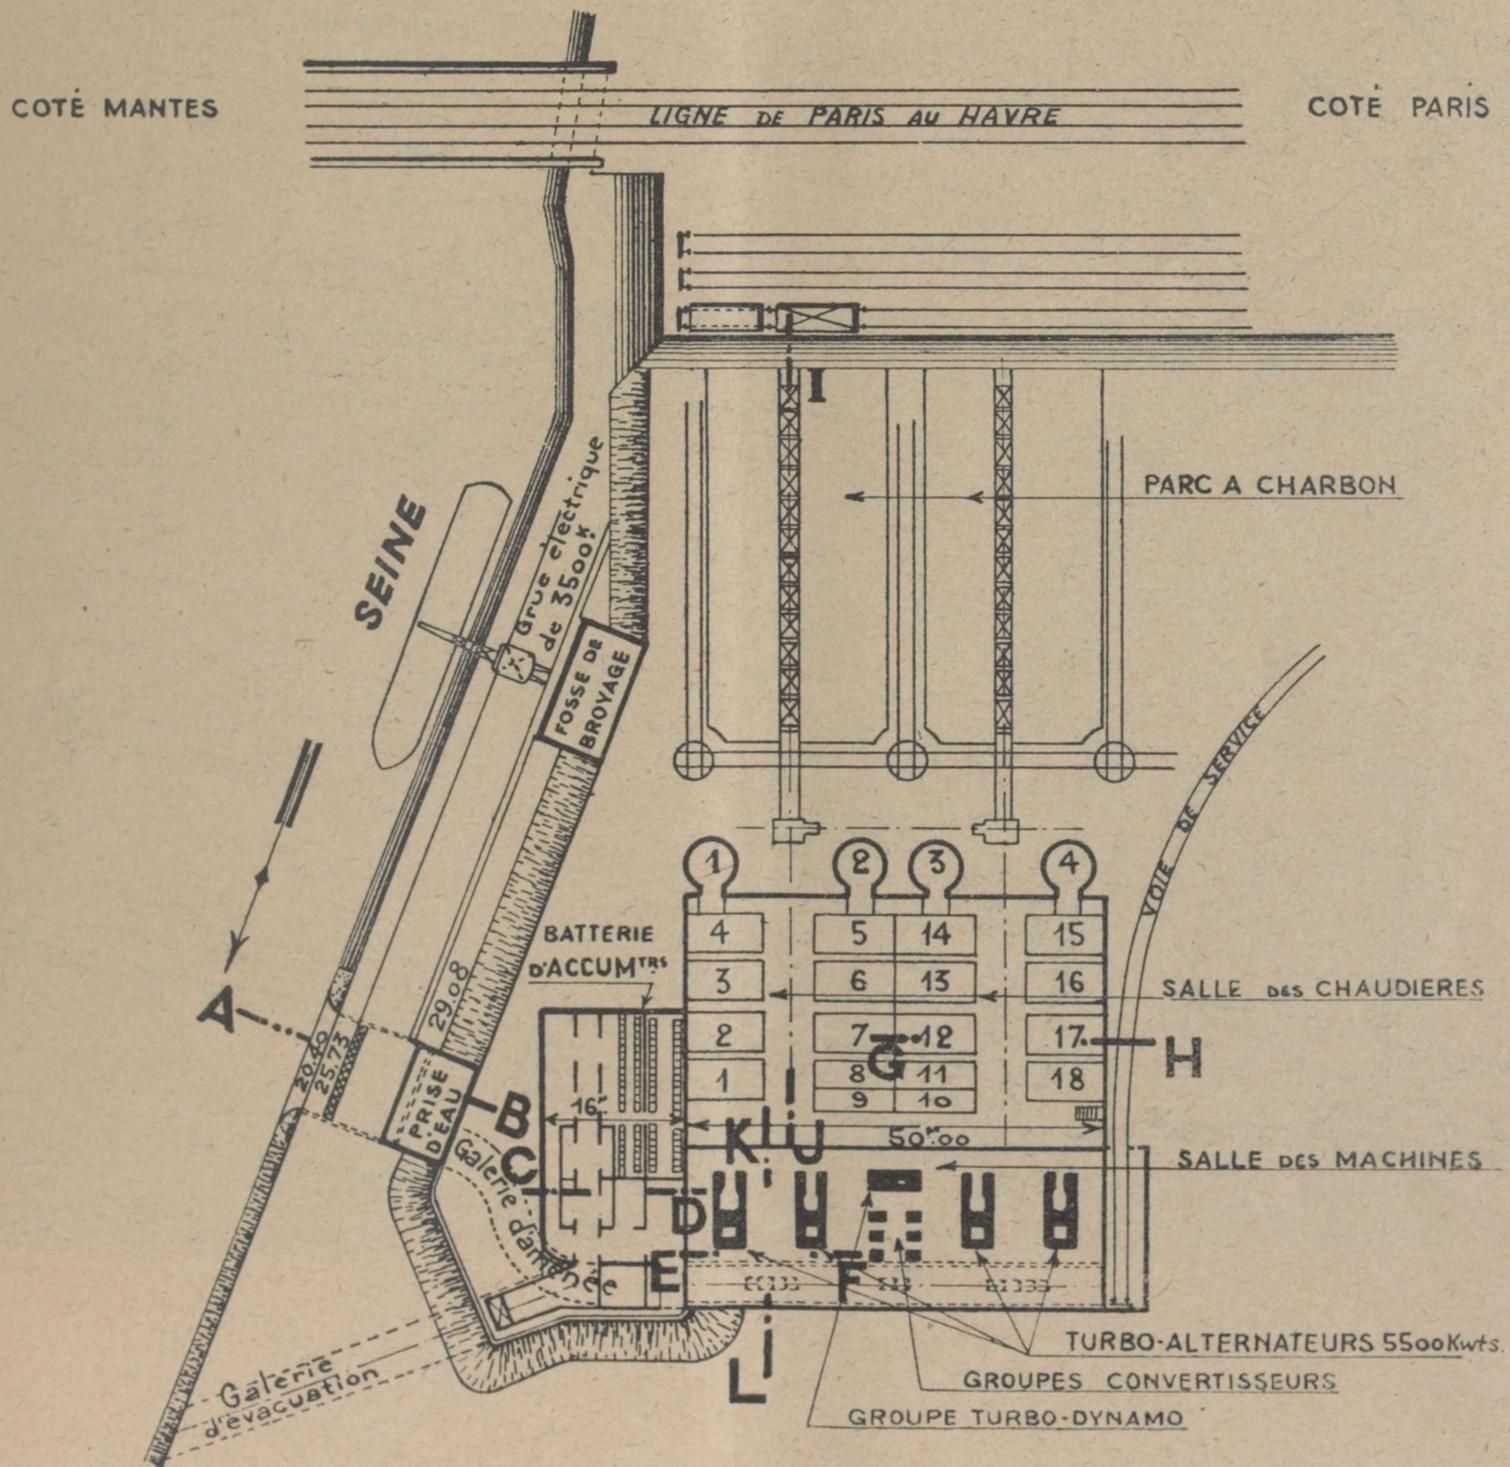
PLAN D'ENSEMBLE DE L'USINE SUD.
